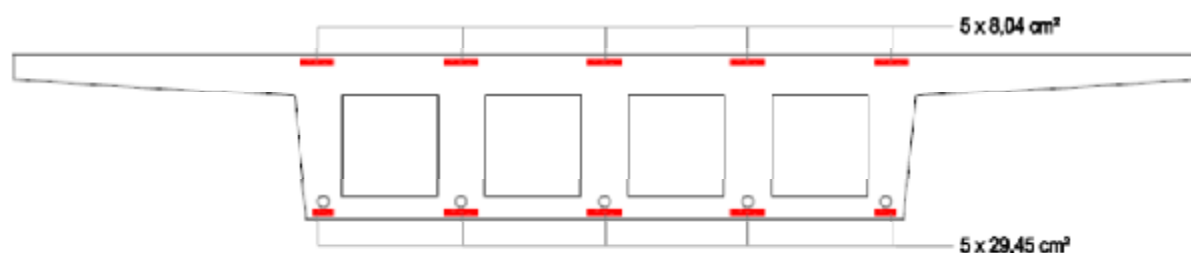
Esquemática das armaduras de flexão do tabuleiro na zona vazada a meio-vão
